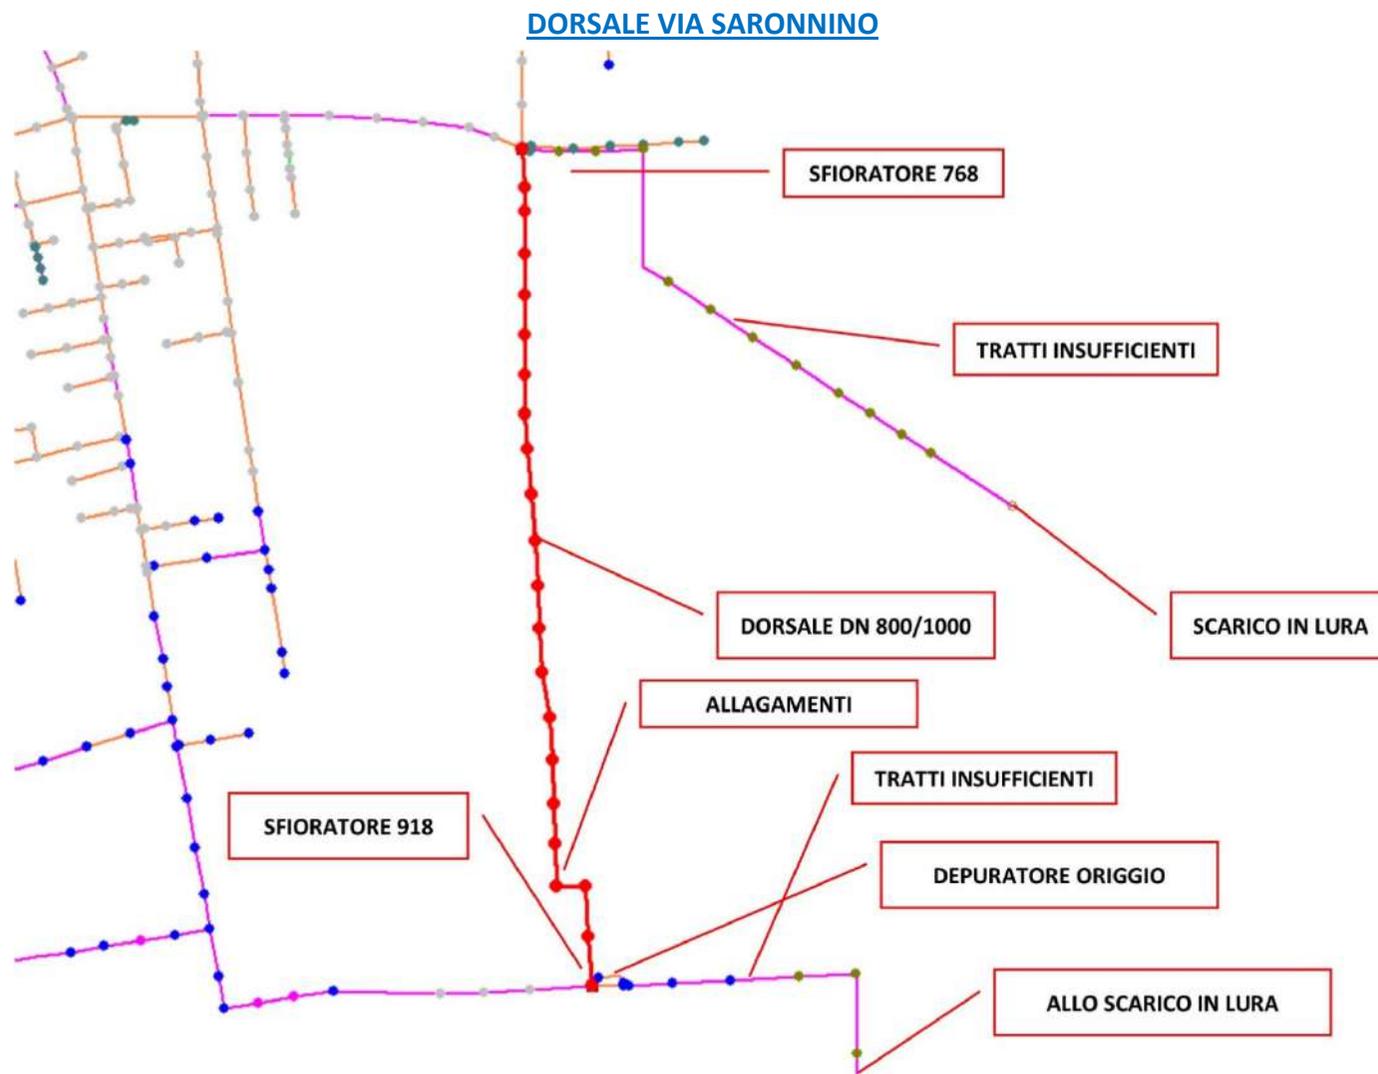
Rappresentazione planimetrica del tratto di rete fognaria
